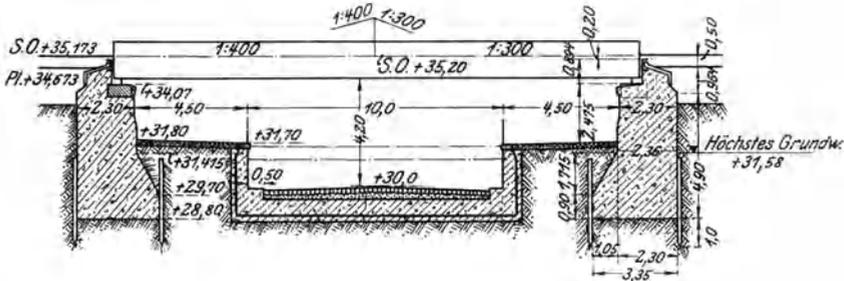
Unterführung der Nauener Straße in Spandau unter den Gütergleisen.
